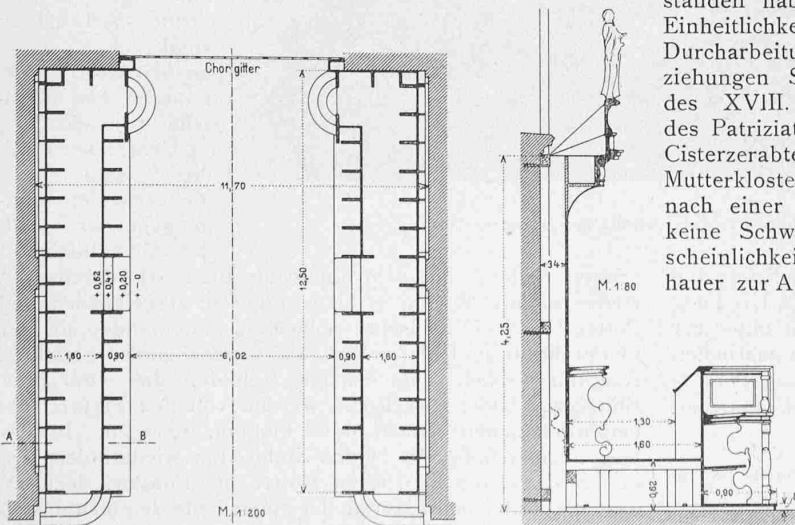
Grundriss 1:200 und Querschnitt 1:80 des Chorgestühls.
